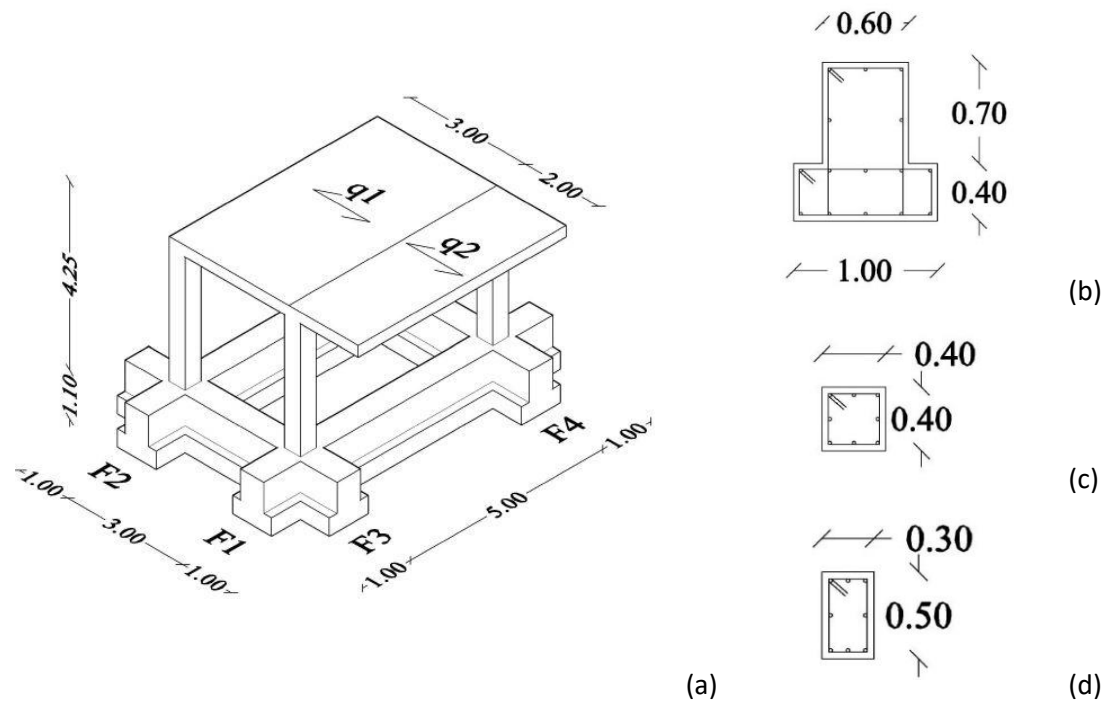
Telaio tridimensionale (in m) e carichi applicati (a); sezione trasversale trave di fondazione (b), colonne (c) e travi in elevazione (d).
